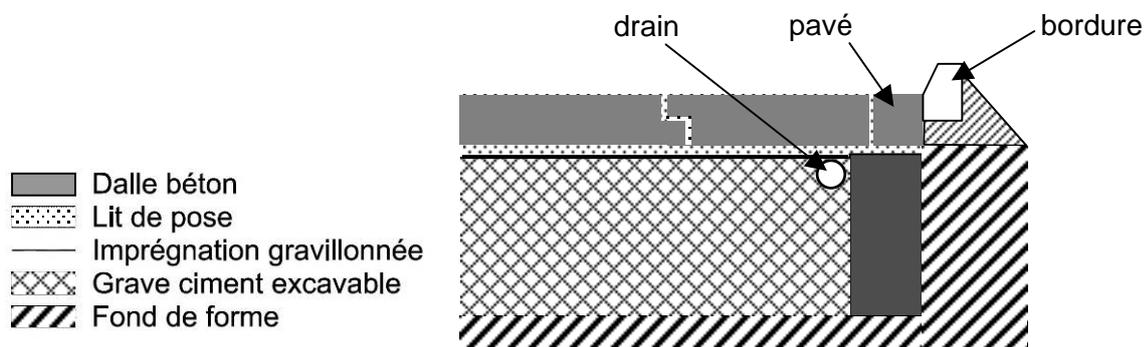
coupe transversale de principe des rives de la CUD à dalles emboîtées.
